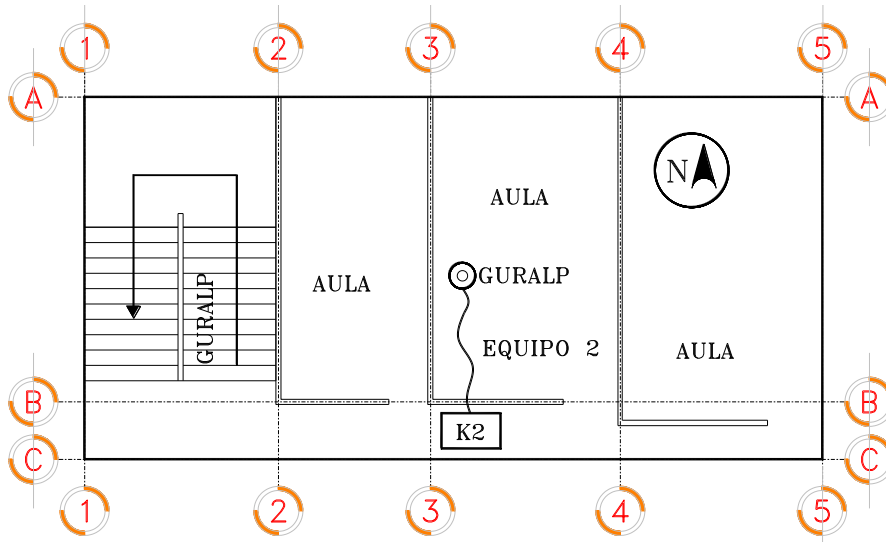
Imagen de distribución de equipos en la planta baja del edificio ING8.
